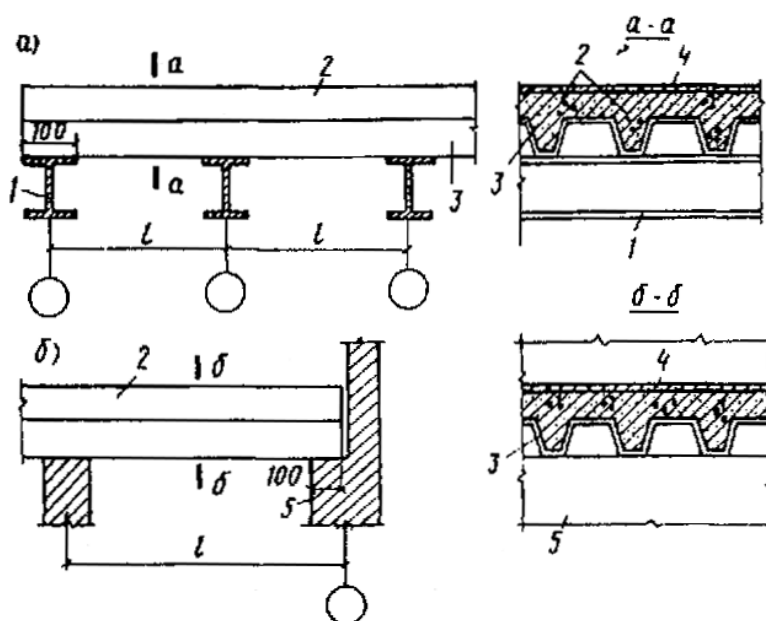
Конструктивные схемы монолитного перекрытия по СПН
